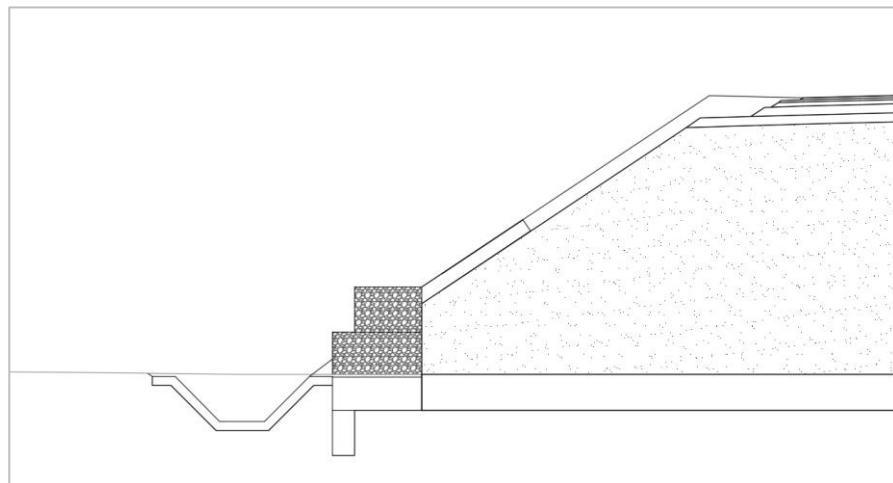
Dettaglio del muro a gabbioi al piede del rilevato, pk 1+150.
